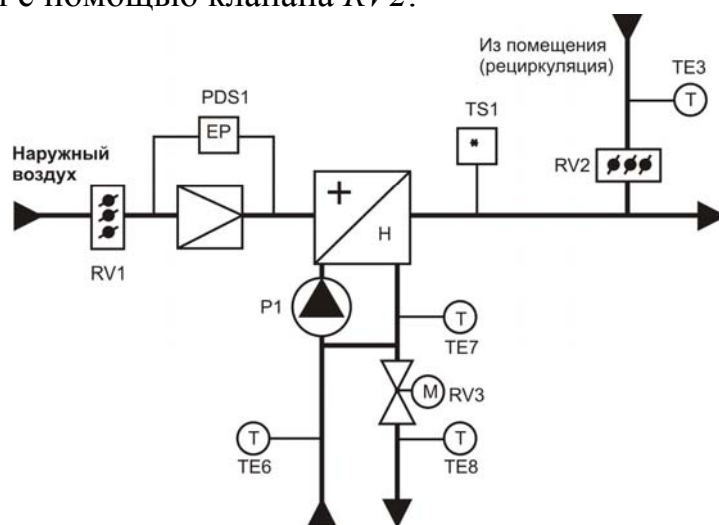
Схема установки к испытанию воздухонагревателя первой ступени
